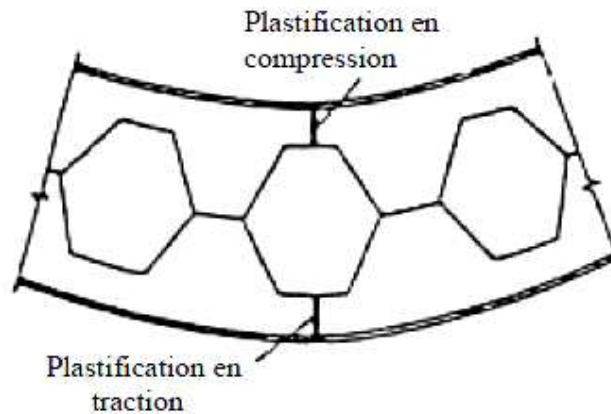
Ruine par flexion transversale de la section perforée [2]
